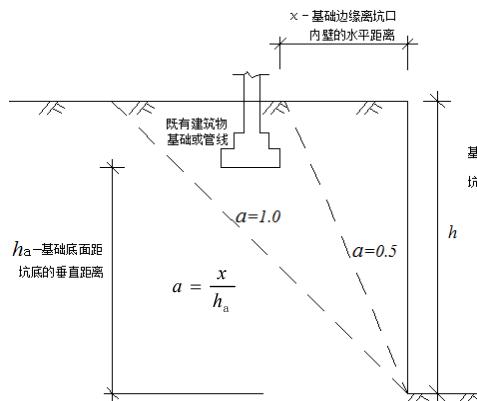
相邻建筑基础与基坑相对关系示意图
